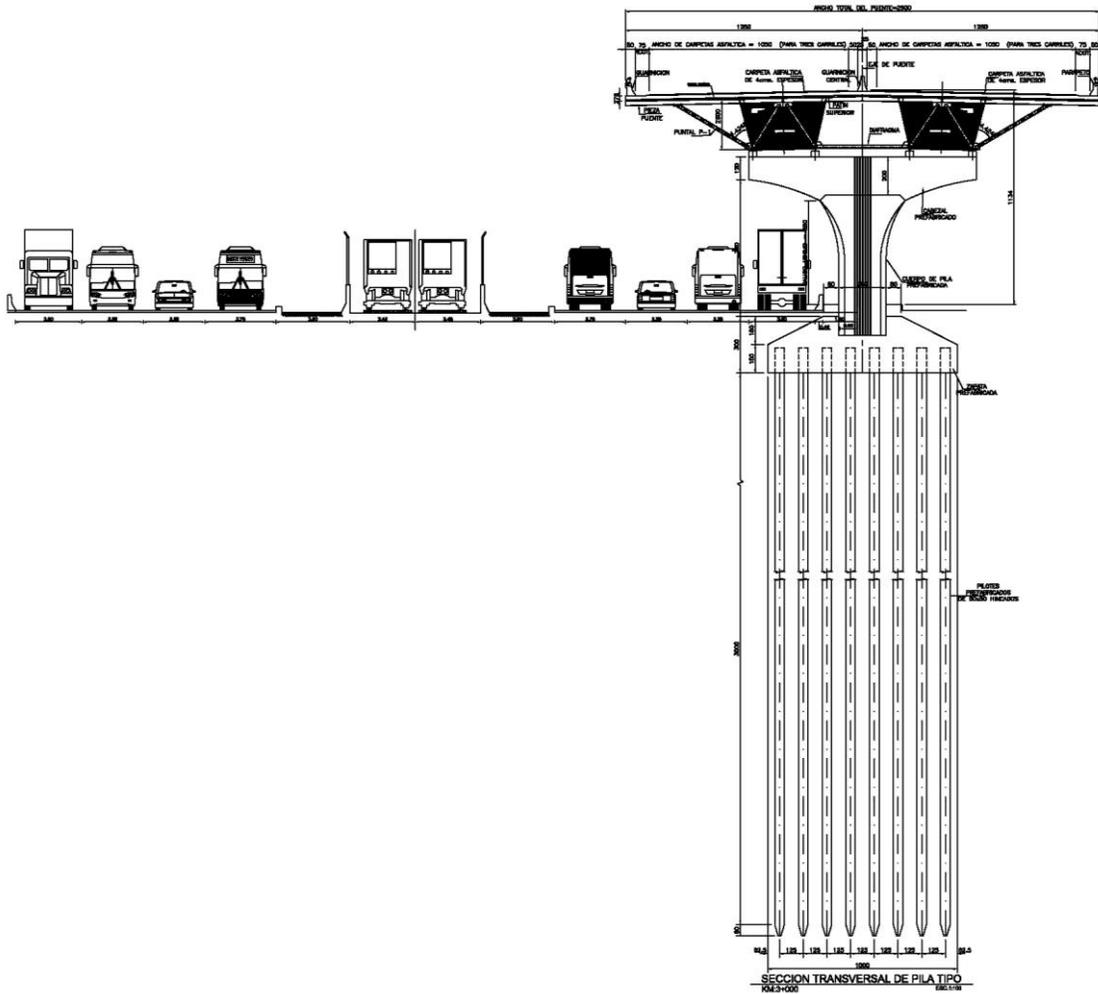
Sección transversal tipo para tramos de tres carriles por sentido A6 cimentados con pilotes.
